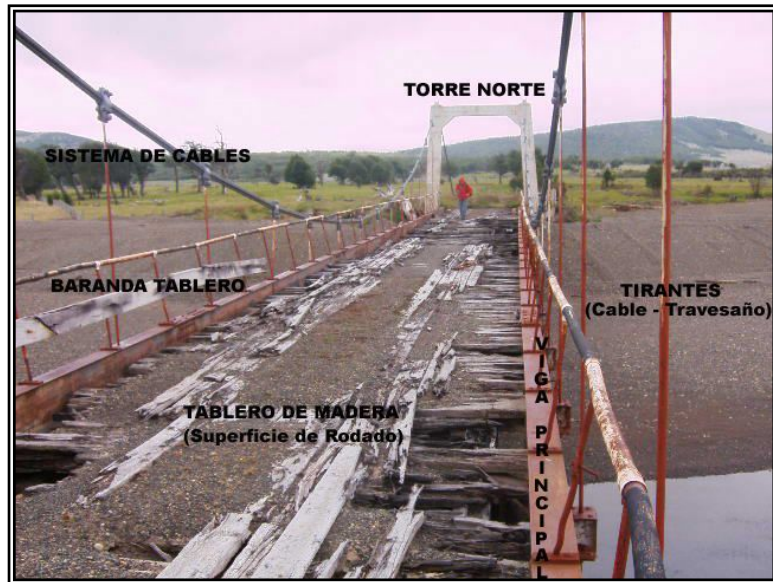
Fotografía que muestra el sistema de cables, las barandas, las vigas principales, la torre norte y la superficie de rodado.
